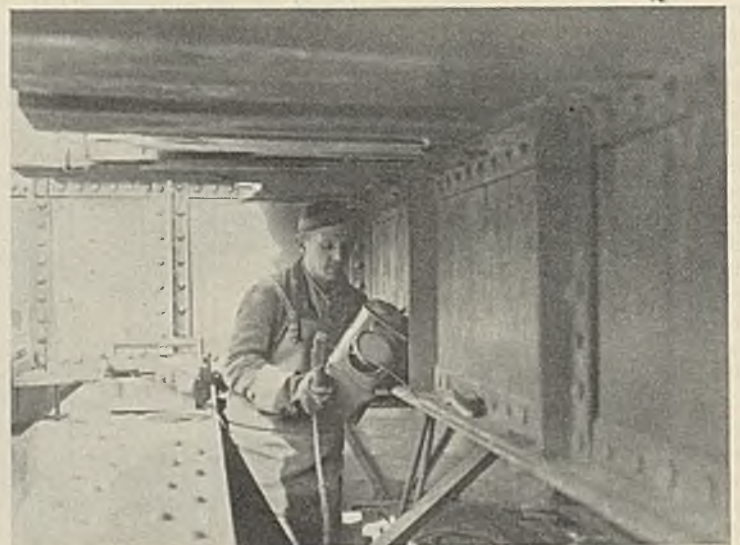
Schweißarbeiten an den Längsträgern, Anschweißen der Gurtplatten.
